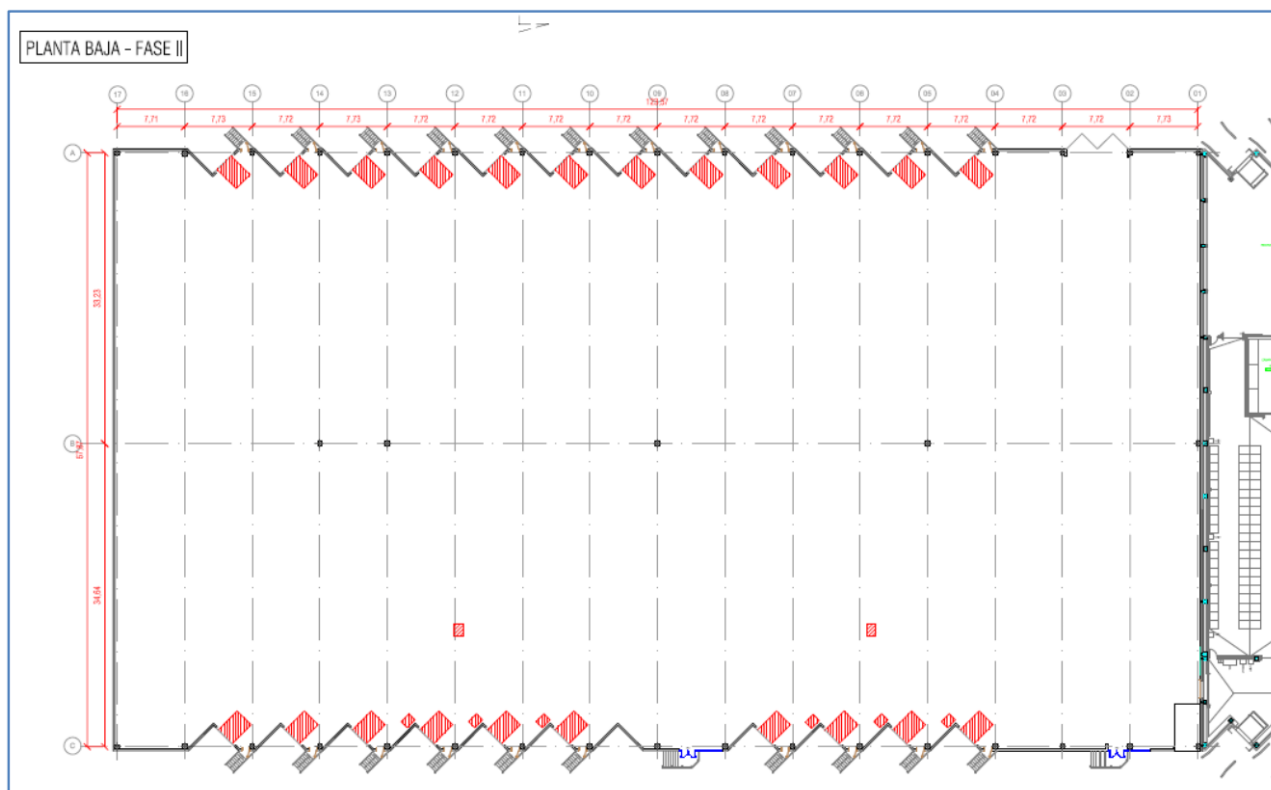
Plano estructura planta baja escenario automático Fuente Elaboración propia
